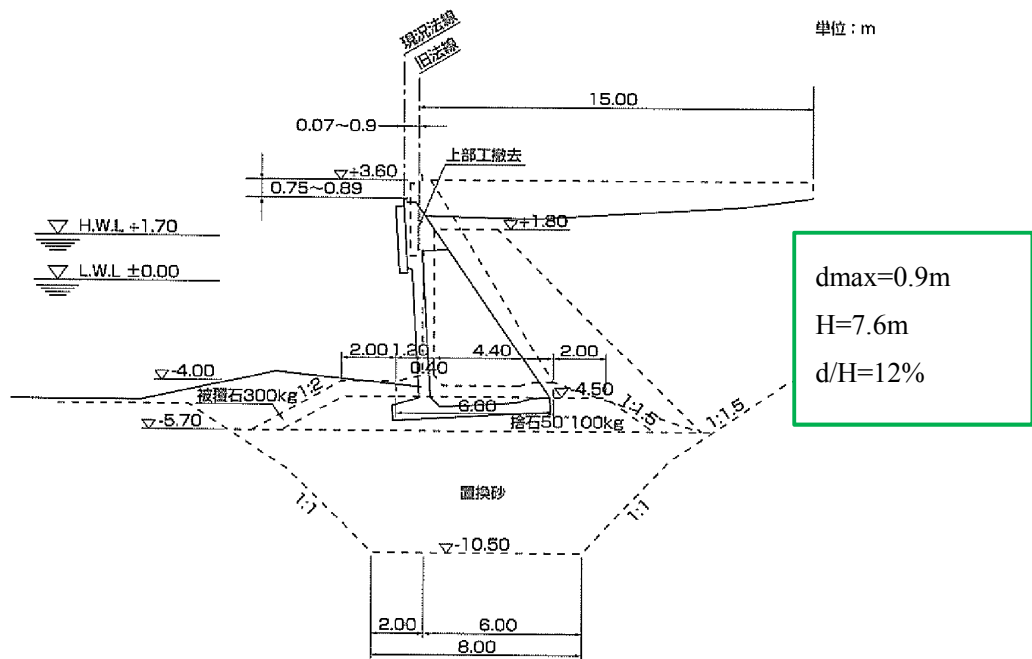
東部内貿埠頭物揚場-4.0m被災断面図 (施設番号①)
